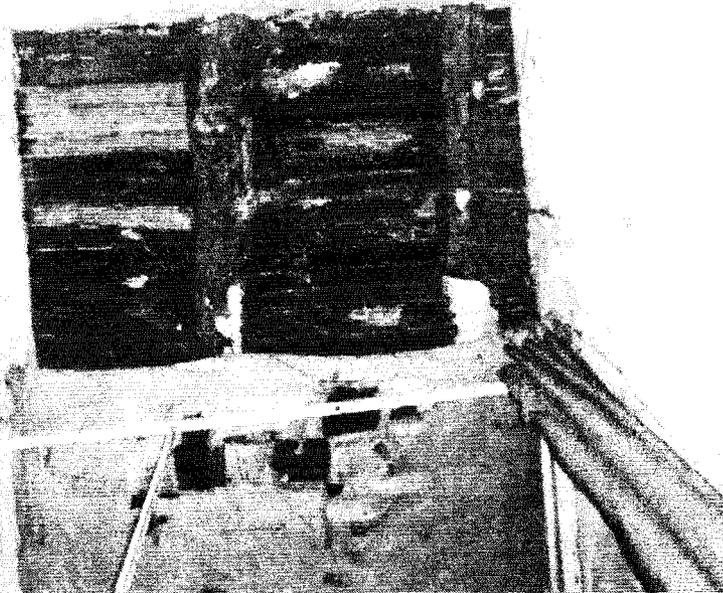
particolare dello stato di degrado del solaio in legno sovrastante l'ingresso dal cortile, con alcuni panconcelli mancanti
